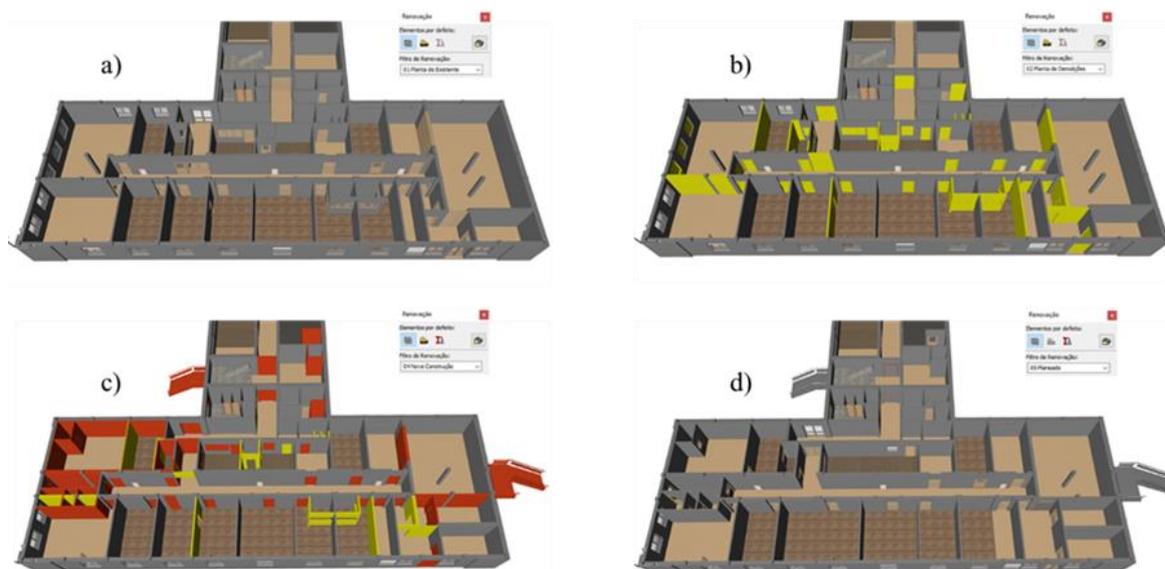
a) Pré-demolição; b) A demolir; c) A construir; d) Estado final.
